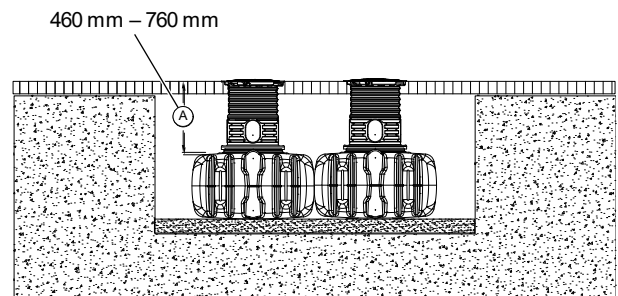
Hauteurs de recouvrement – Exemple FLAT
